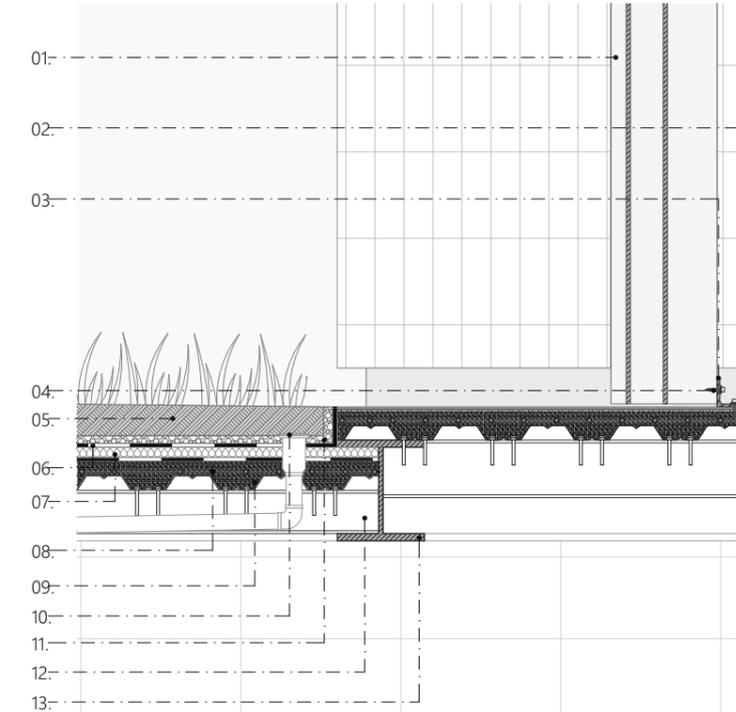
Detalle constructivo Gráfico: Elaboración propia
